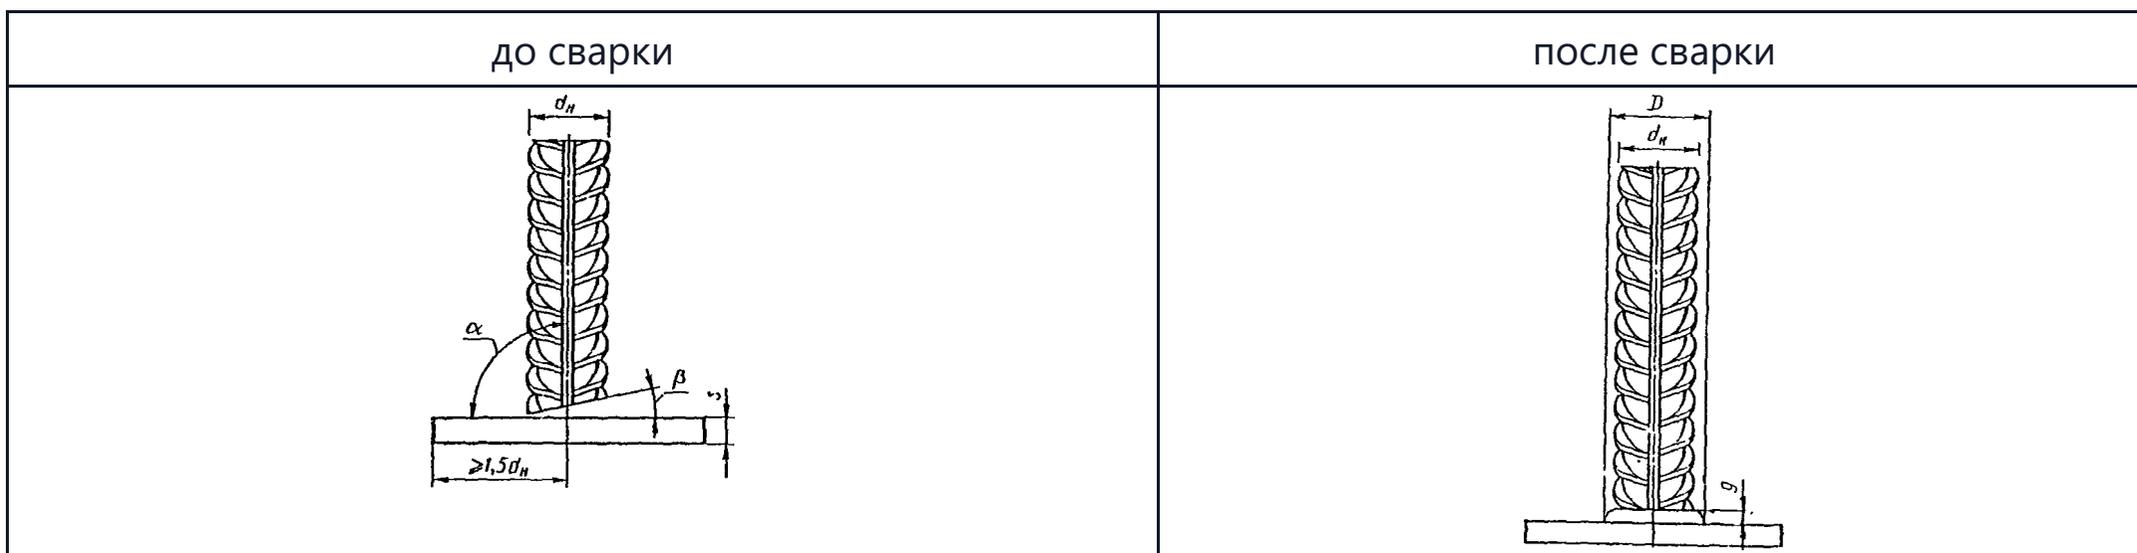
Конструкция таврового соединения, выполняемого сваркой под флюсом без дополнительного присадочного материала (типа Т1-Мф и Т2-Рф)
